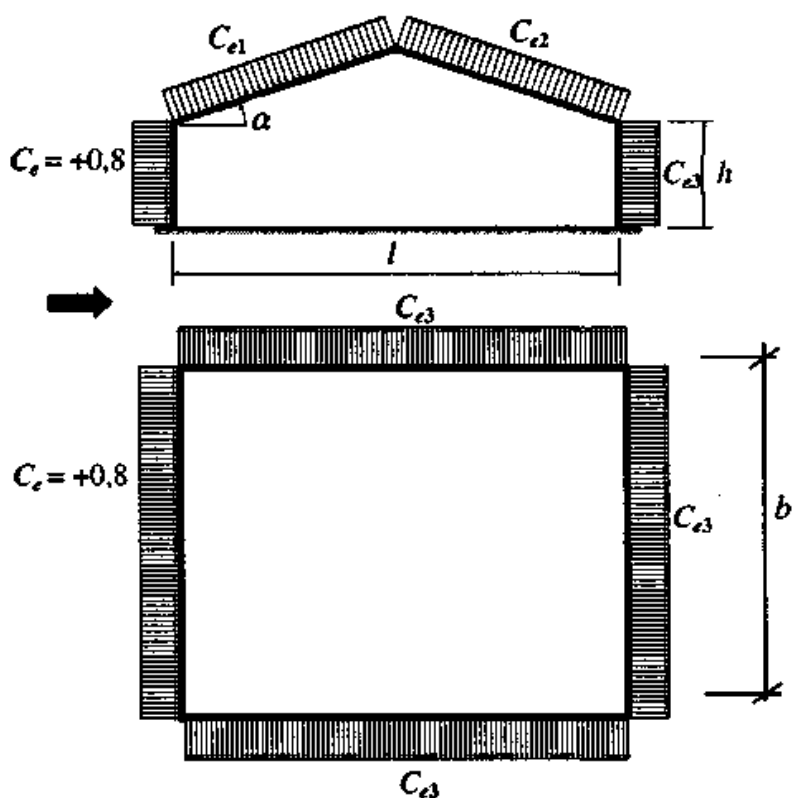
Схема 2 Будівлі з двосхилими покриттями
